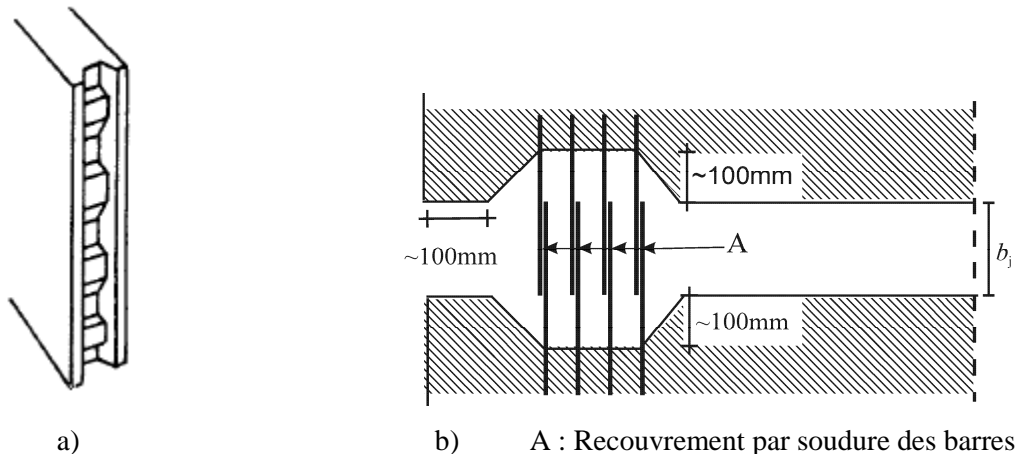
a) Joint vertical cranté. b) Transfert d'effort par soudure.
